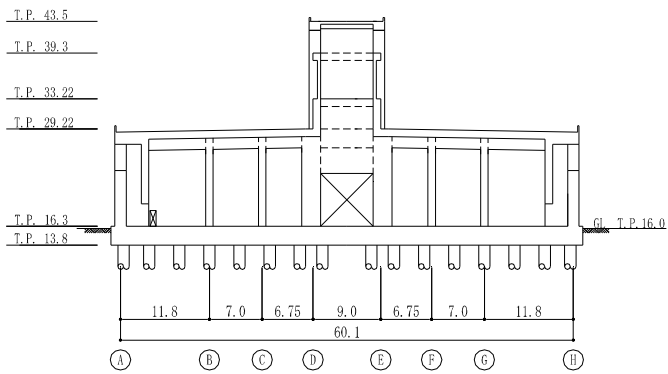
B-B 断面図 (EW 方向) (単位：m)
